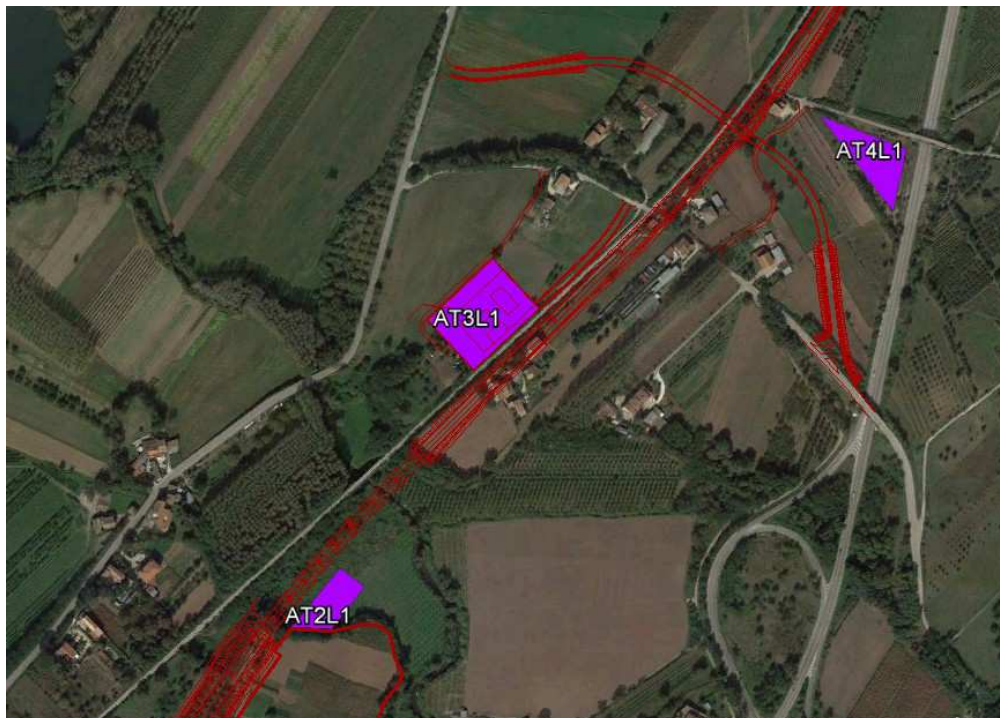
Ubicazione cantiere AT.2-3-4.L1
